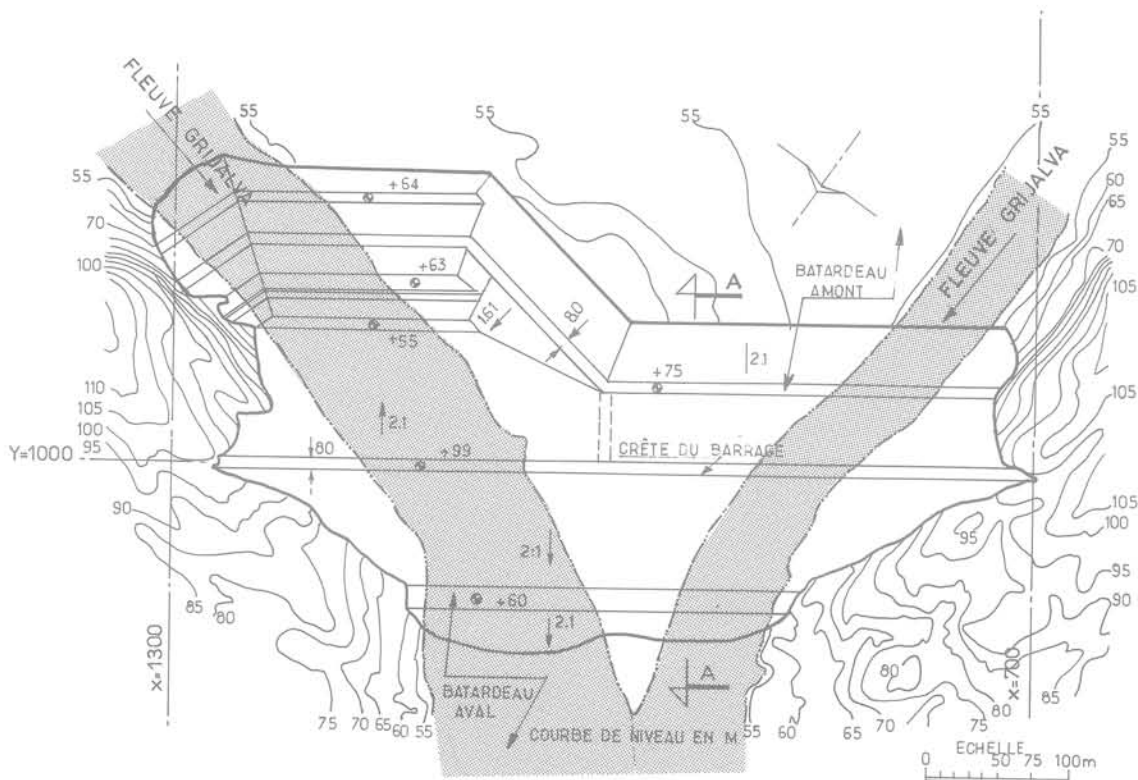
Plan du projet avec repérage de la coupe AA.
